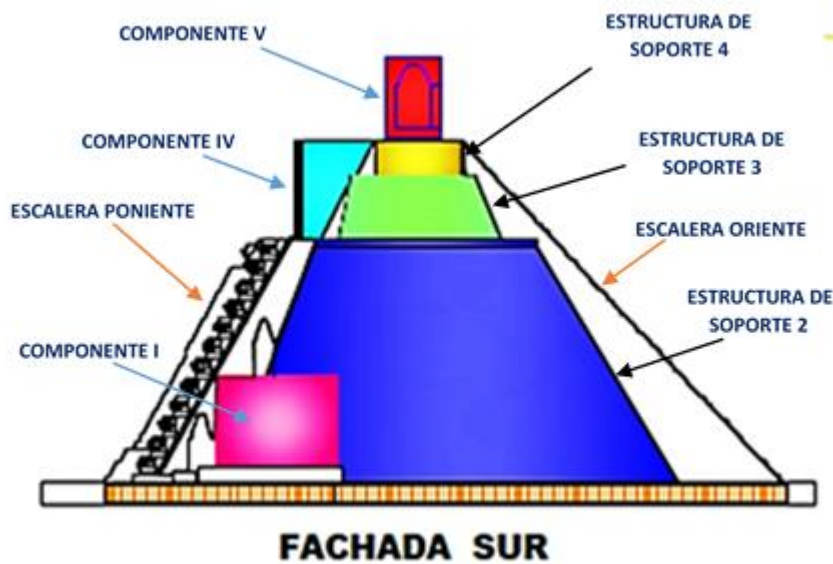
Cortés Juan. Fachada Sur del edificio del Adivino indicando la posición de los componentes, estructuras de soporte y escaleras. 2016. Planos arquitectónicos 08. Acervo J. Cortés.
